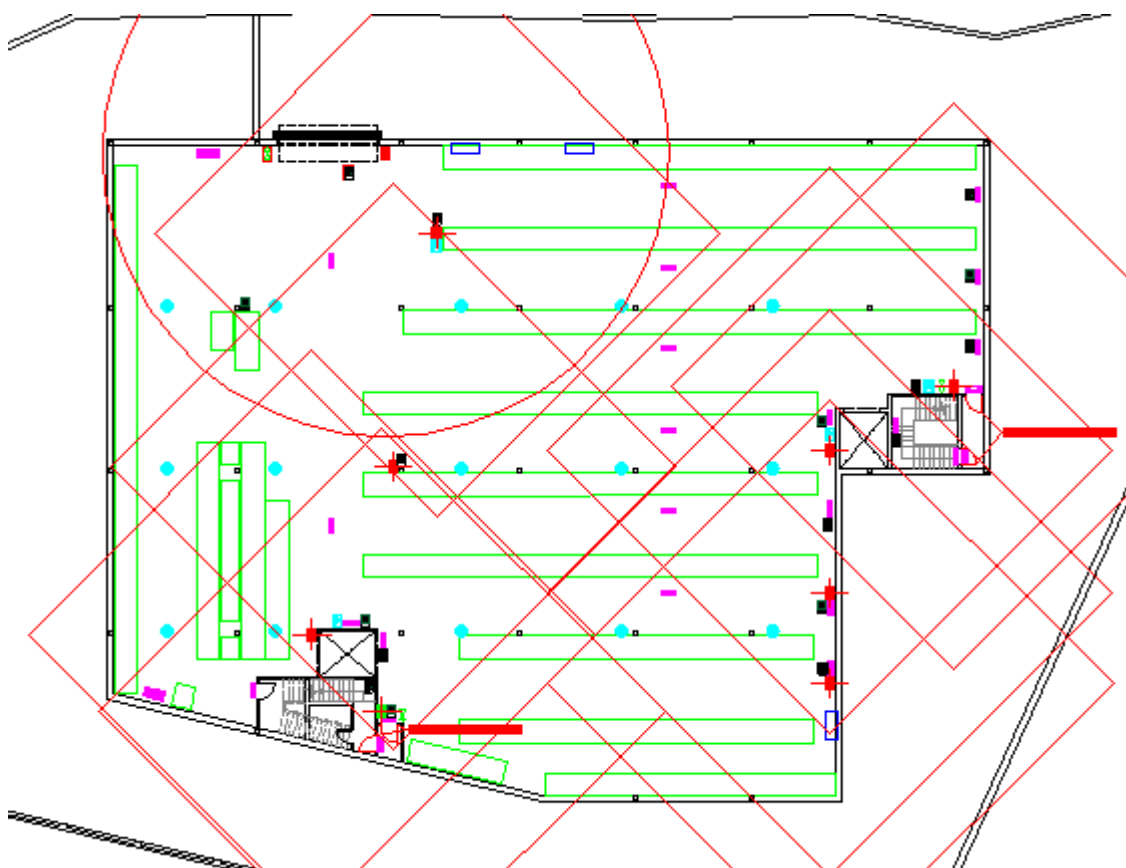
Superficie cubierta por los extintores en la planta sótano del edificio Almacén.
